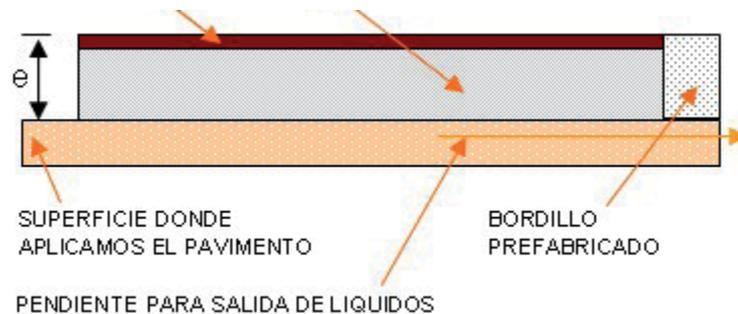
Dibujo sección Pavimento continuo de caucho (PVJL-03)
